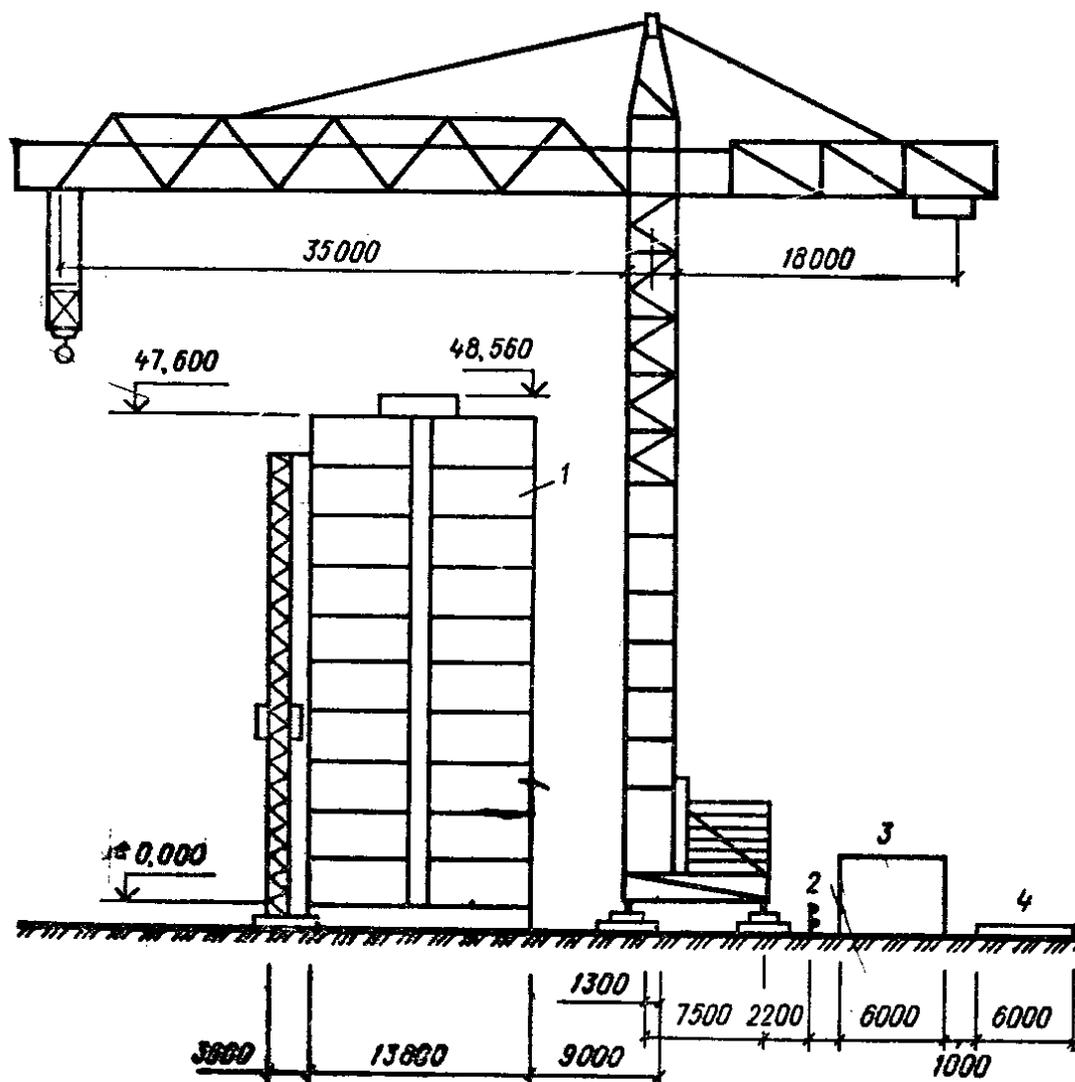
Схема установки башенного крана, подъемника и расположение складов и дороги для движения панелевозов при монтаже крупнопанельных зданий:
